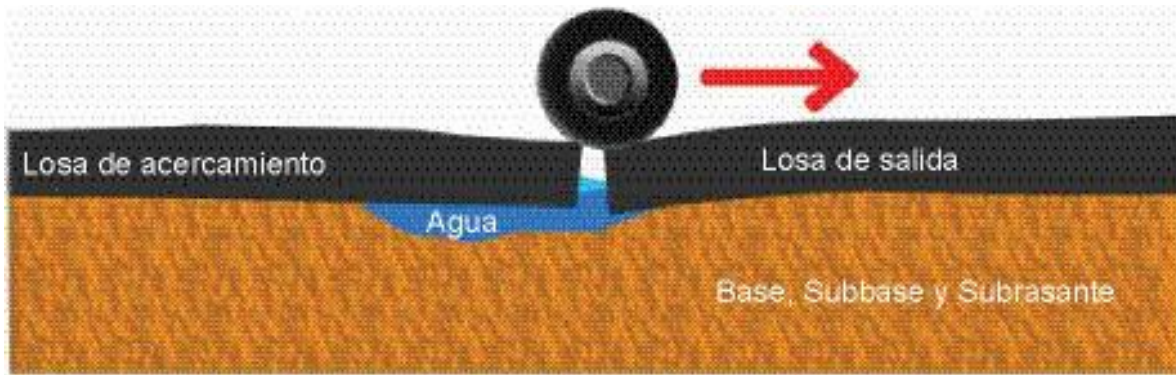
b.7 Bombeo en pavimentos rígidos.
